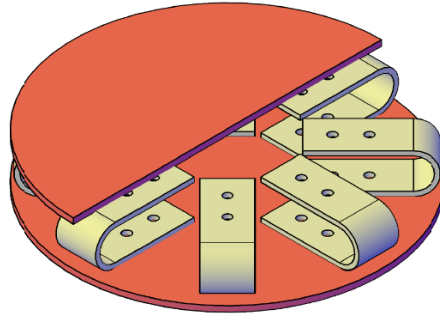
Sistema de protección sísmica multidireccional basada en elementos U-Shaped
